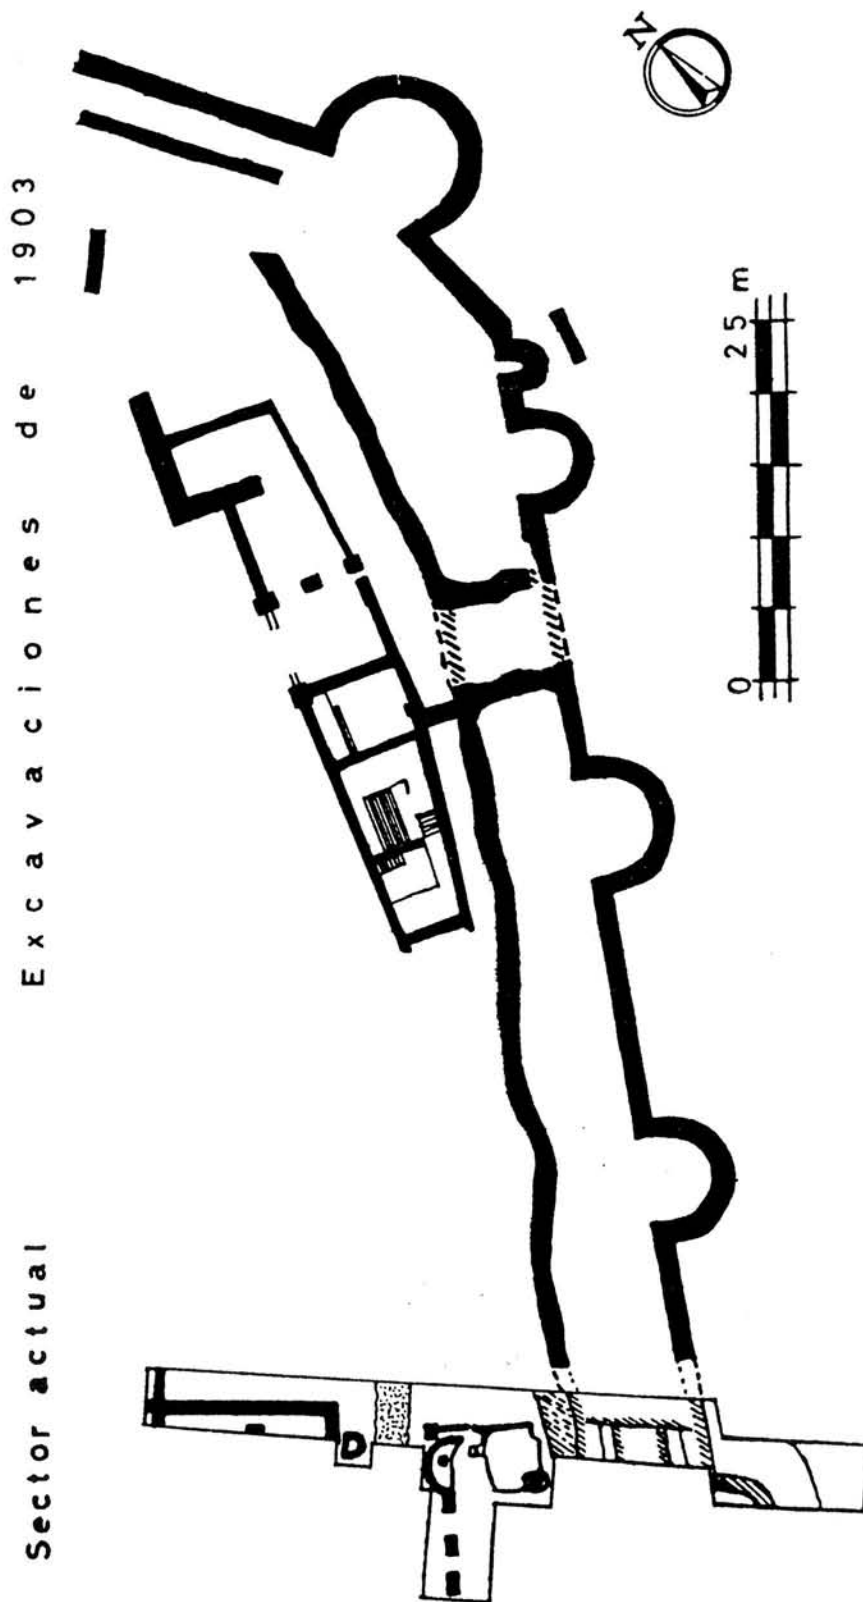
Plano Conjunto de las excavaciones de 1903 y 1973.
